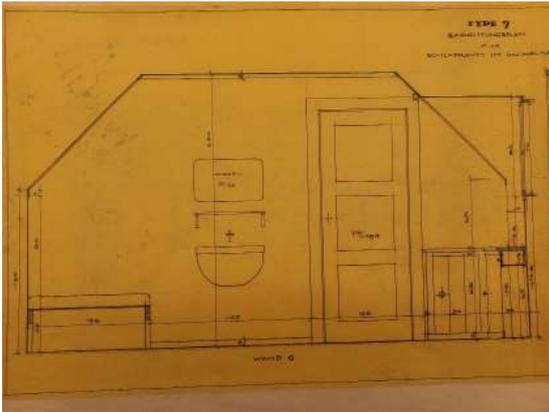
Schlafraum im Dachausbau. Einrichtungssplan. Wand G
